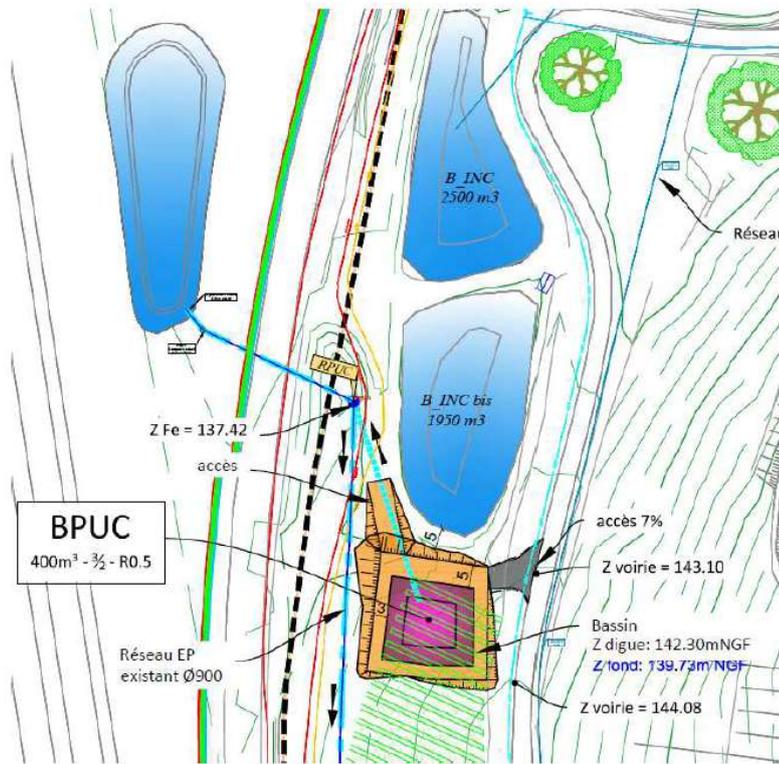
Aménagement de la zone 3 – Extrait du plan 3
